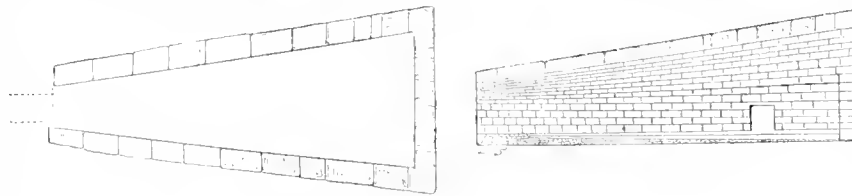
Émissaire du lac d'Albano : plan et section dans la longueur des constructions de la bouche de sortie.
